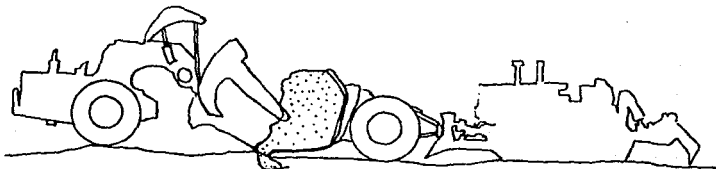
FASE DE LLENADO DEL SCRAPER
